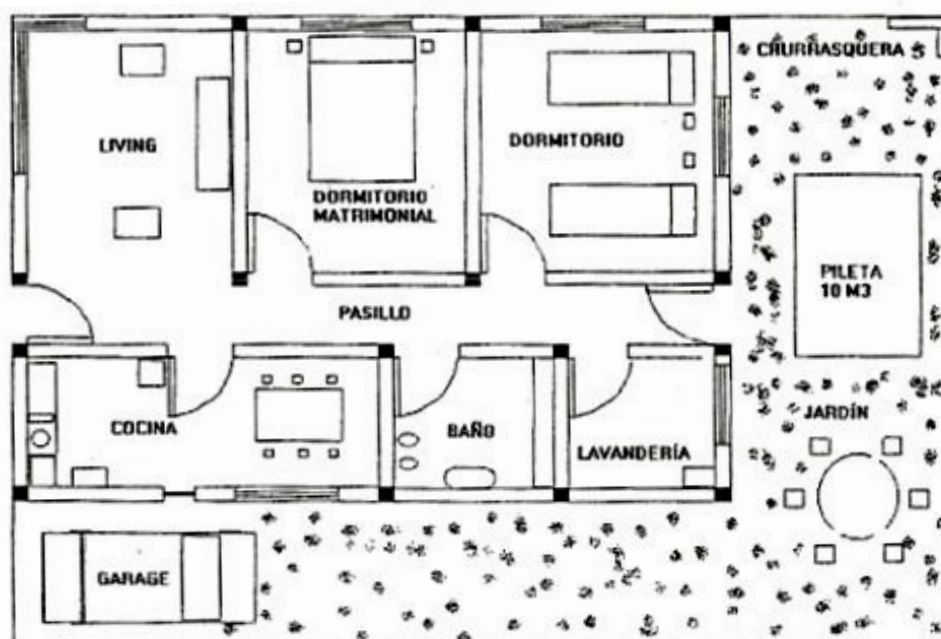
Plano de planta con detalle de aberturas y mobiliario
